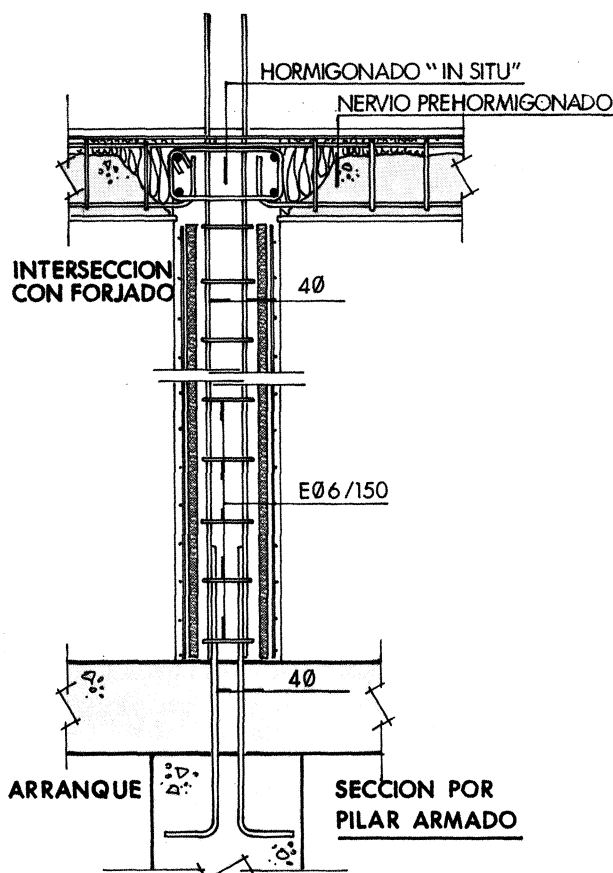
Detalle constructivo de muro D-P II intermedio en arranque e intersección con forjado.
